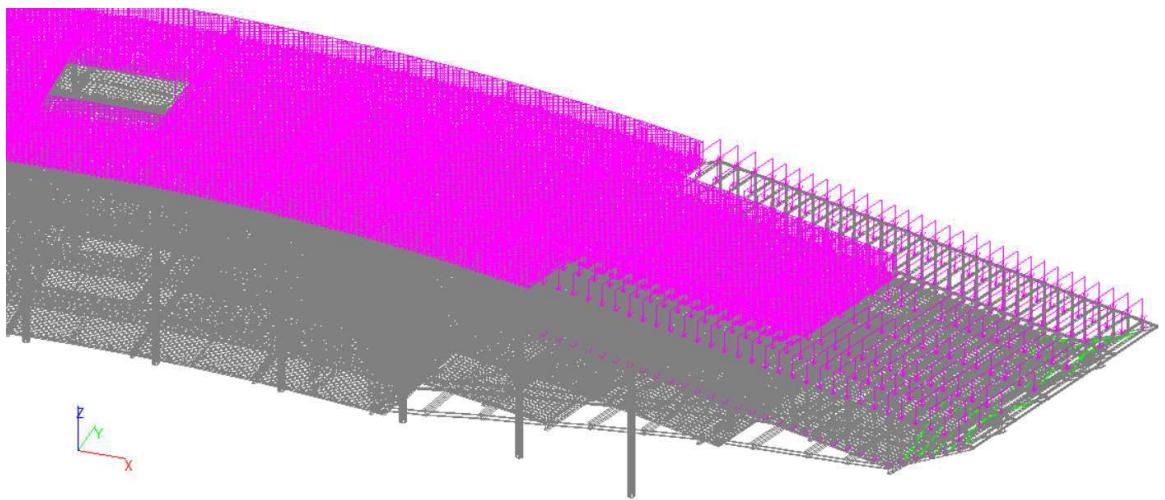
Снеговая нагрузка (фрагмент здания)
